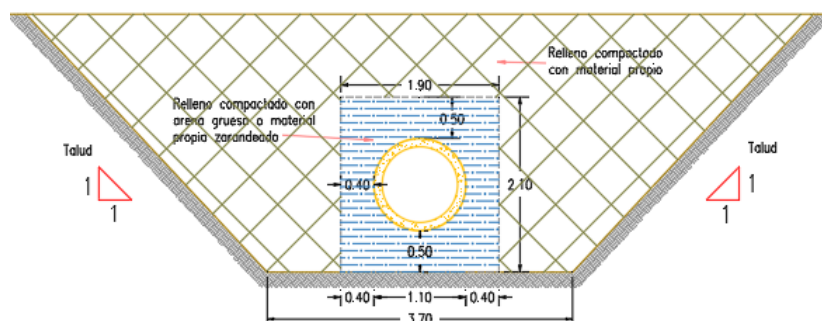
Detalle de relleno de zanja para tubería ONP.
